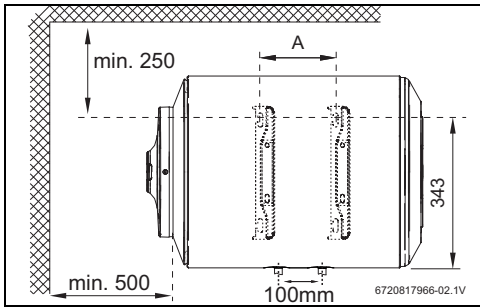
Dimensiones en mm (Instalación en posición horizontal)
